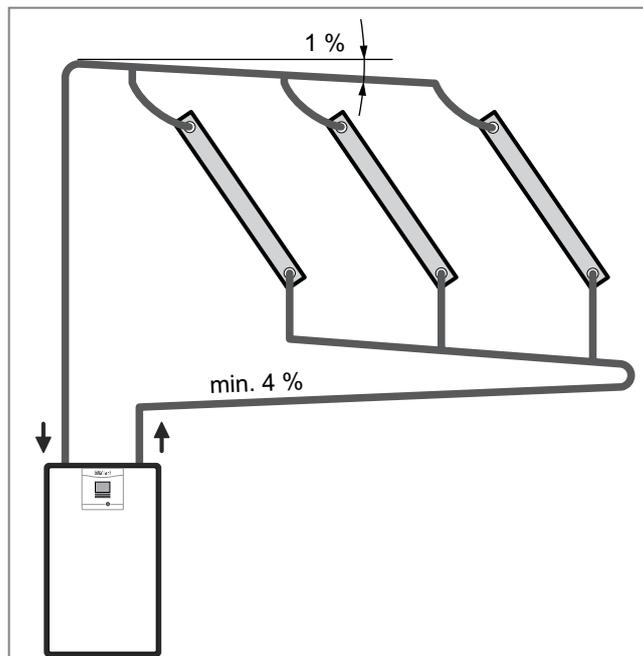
Collegamento idraulico per l'installazione su tetto piano
